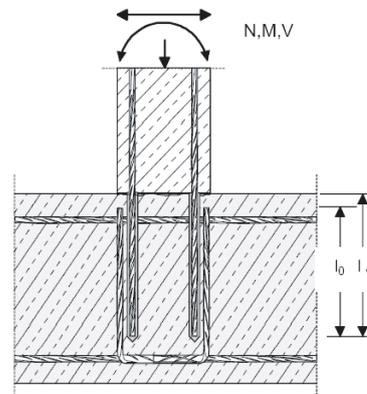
giunzione per sovrapposizione di pilastri sollecitati a flessione o muri a fondazioni.
